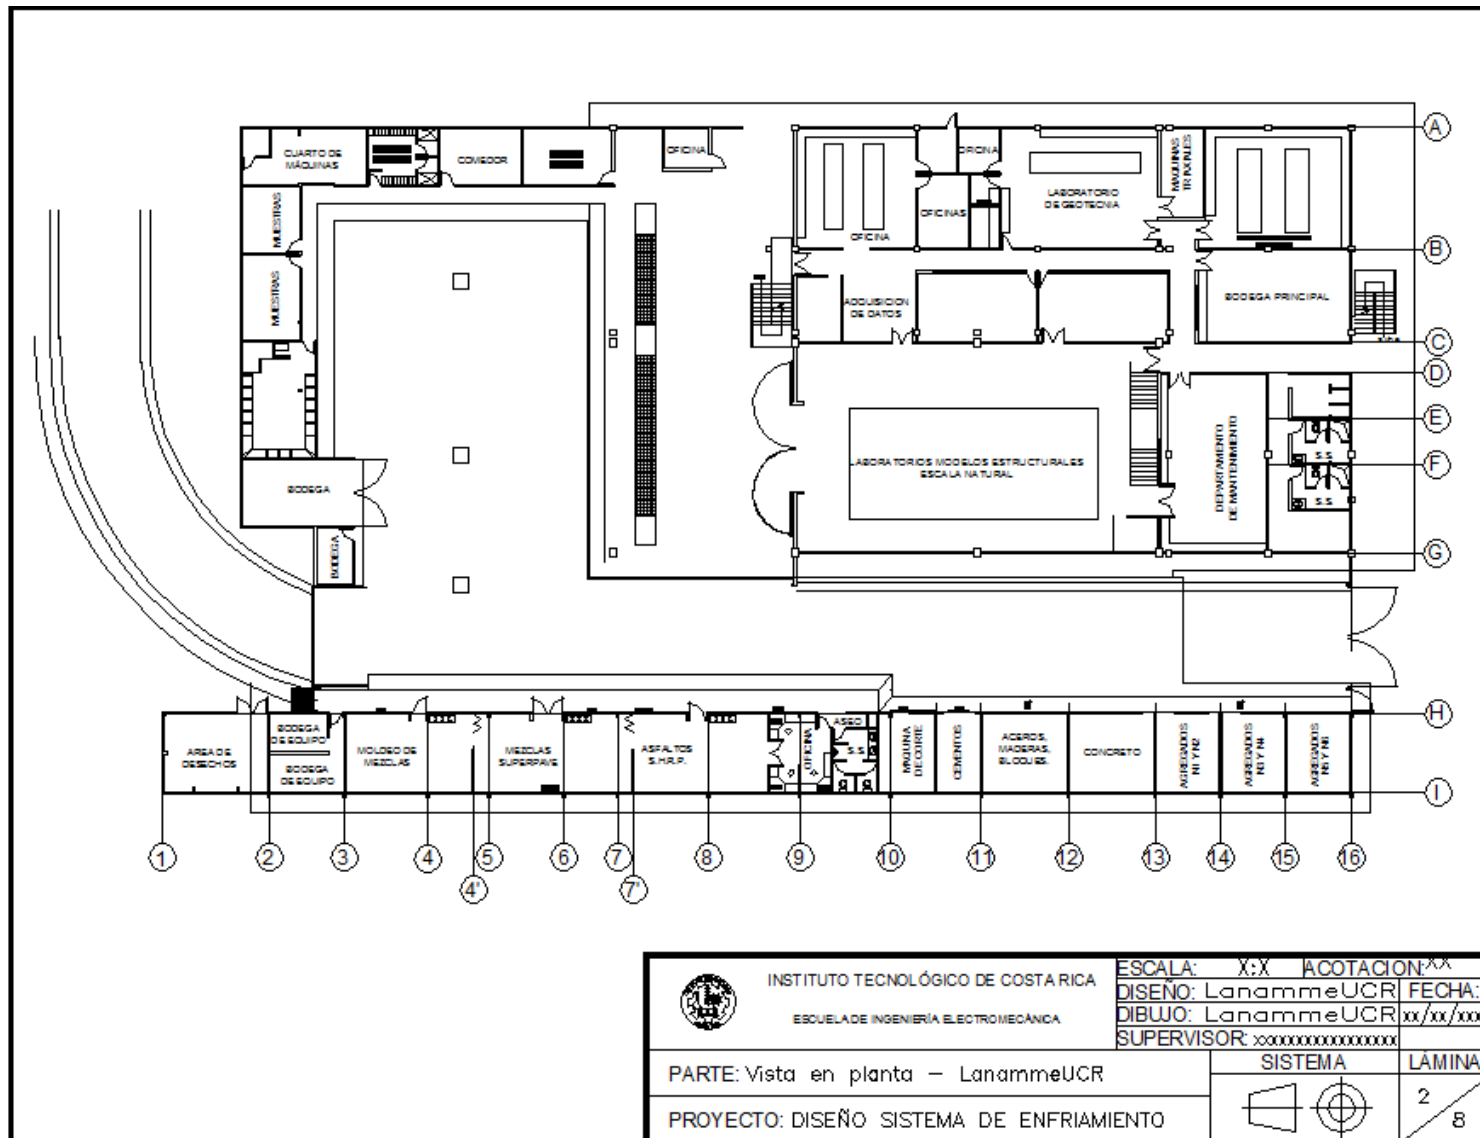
Vista en planta del Edificio A, LanammeUCR.
